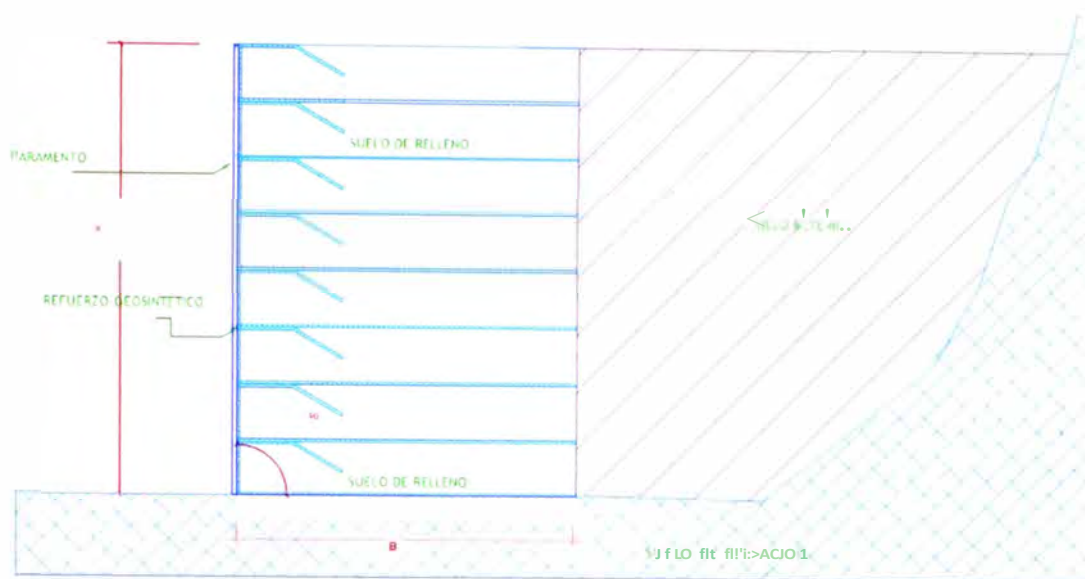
Elementos de un Muro de Suelo Reforzado
